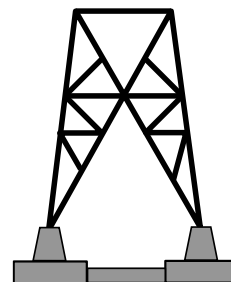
Cimentación superficial a base de zapatas aisladas en una torre de transmisión eléctrica tipo.
